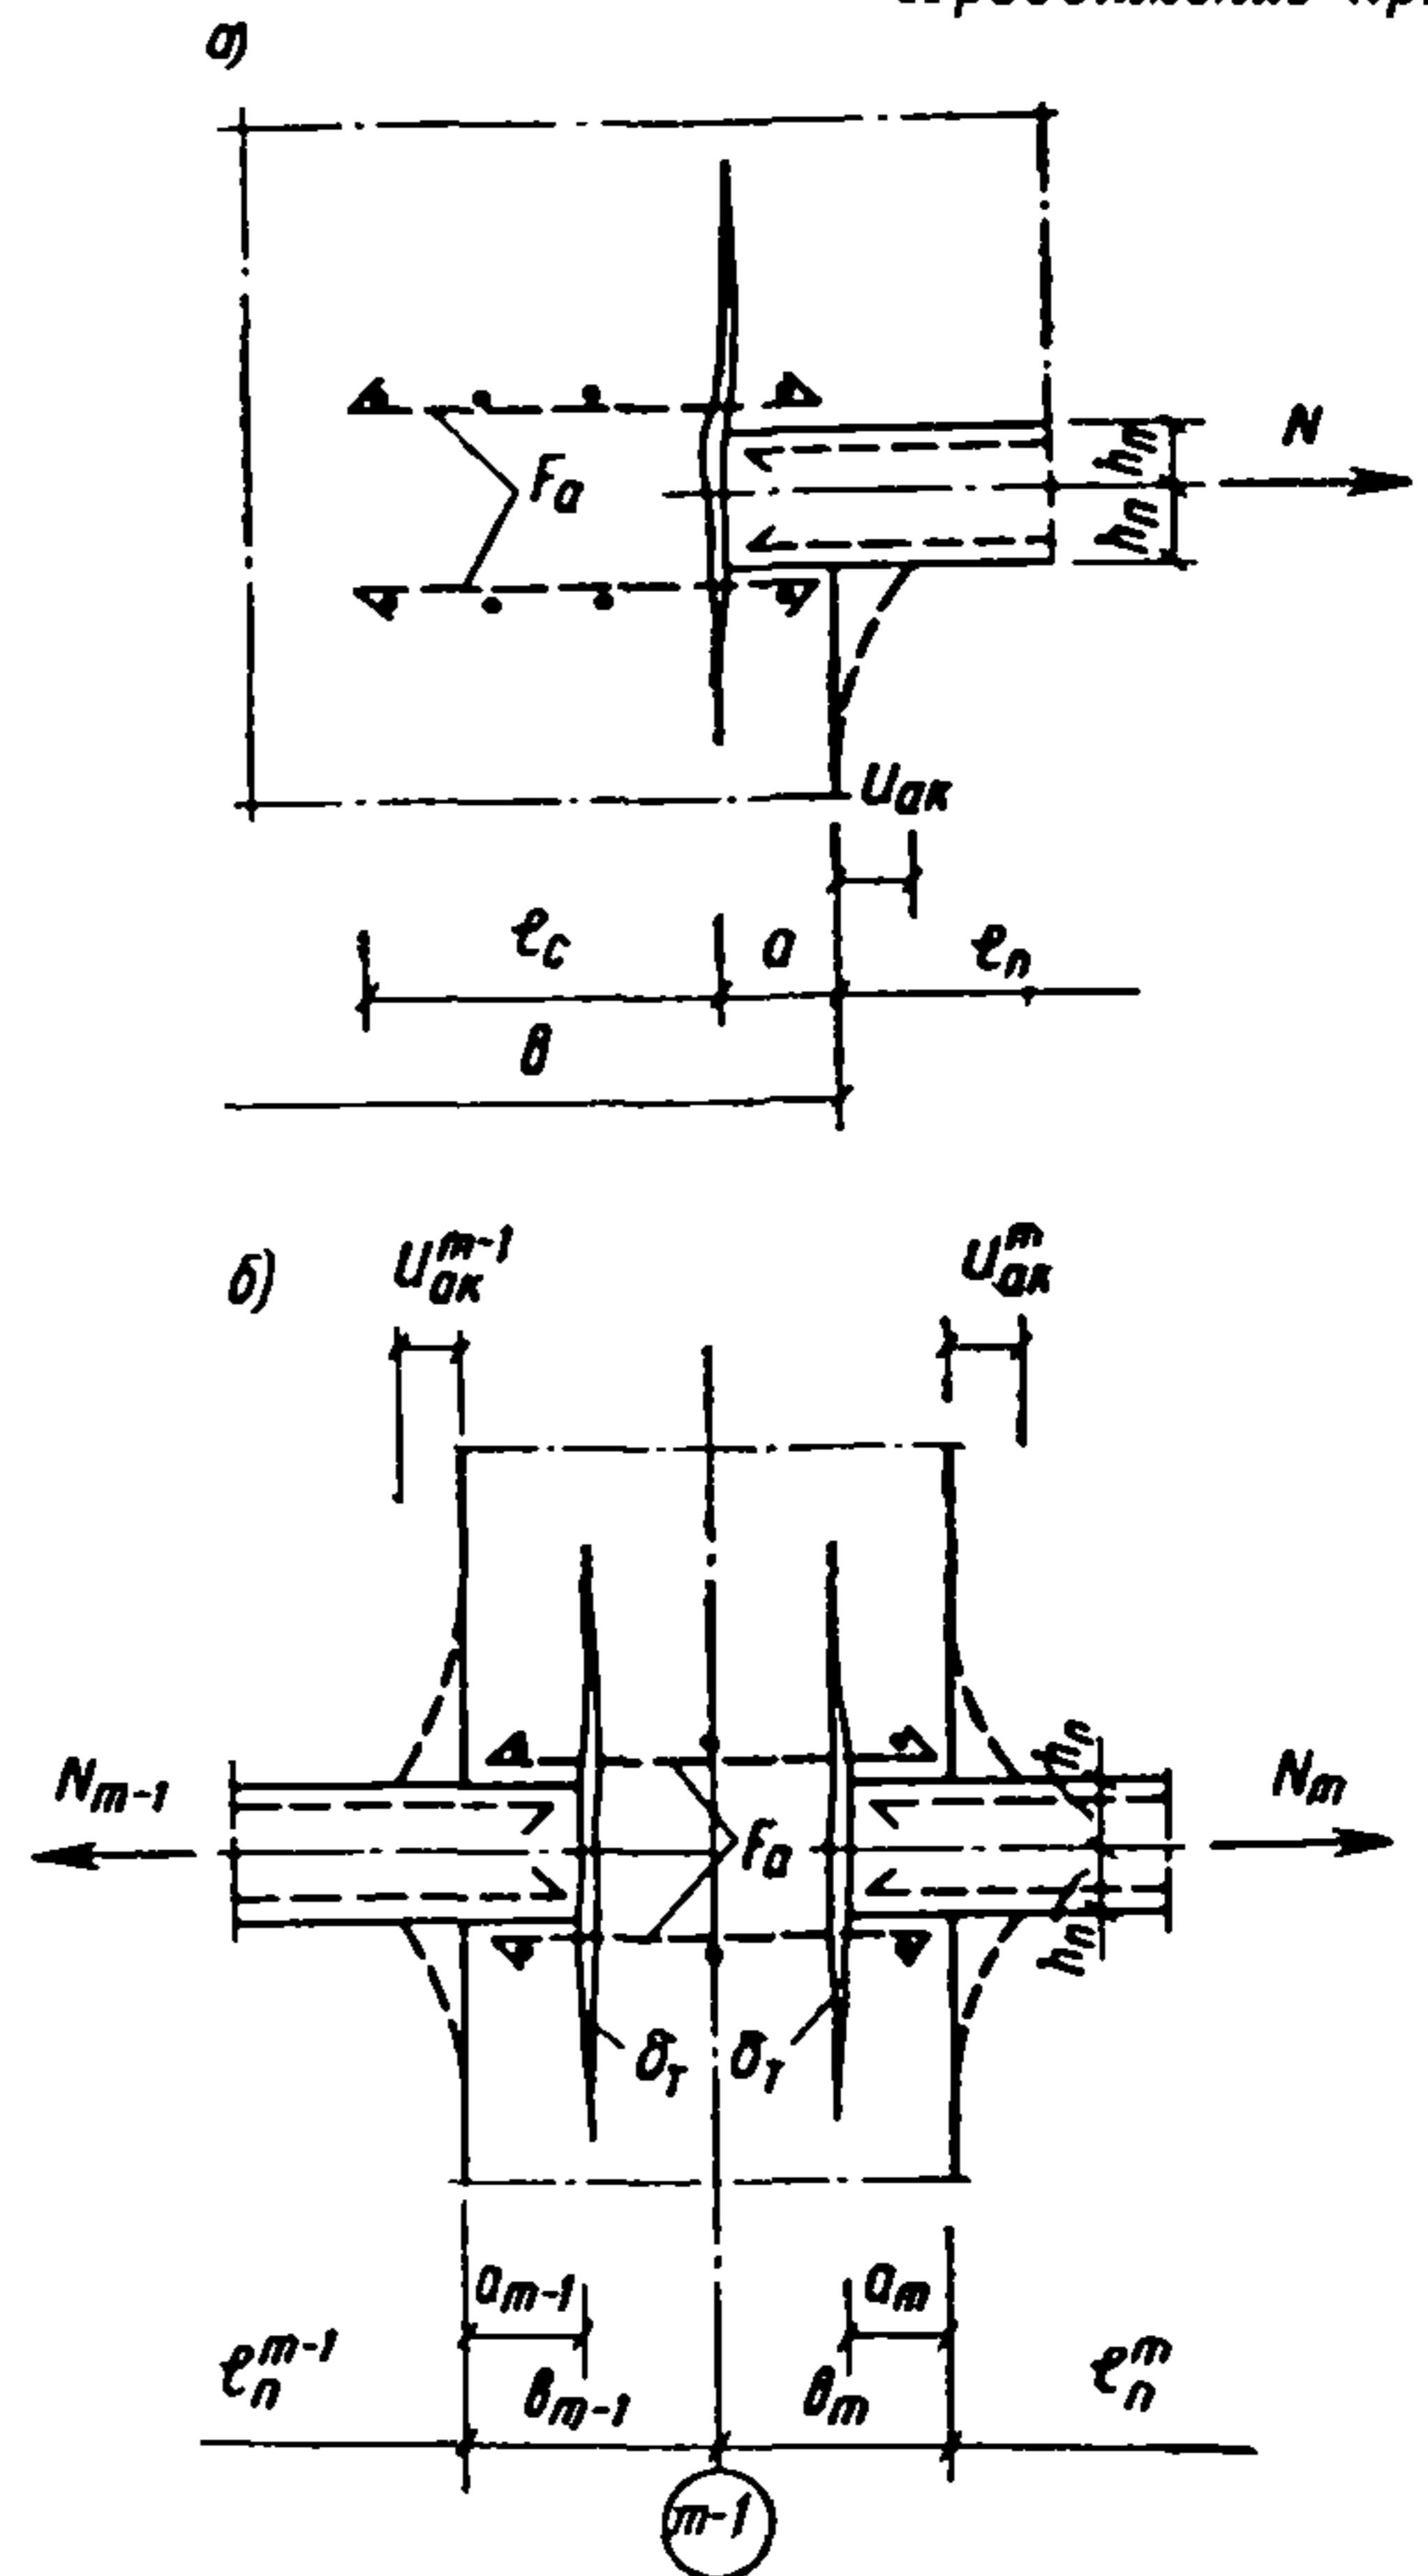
Работа армированной кладки после образования трещин в местах заделки армированных элементов
